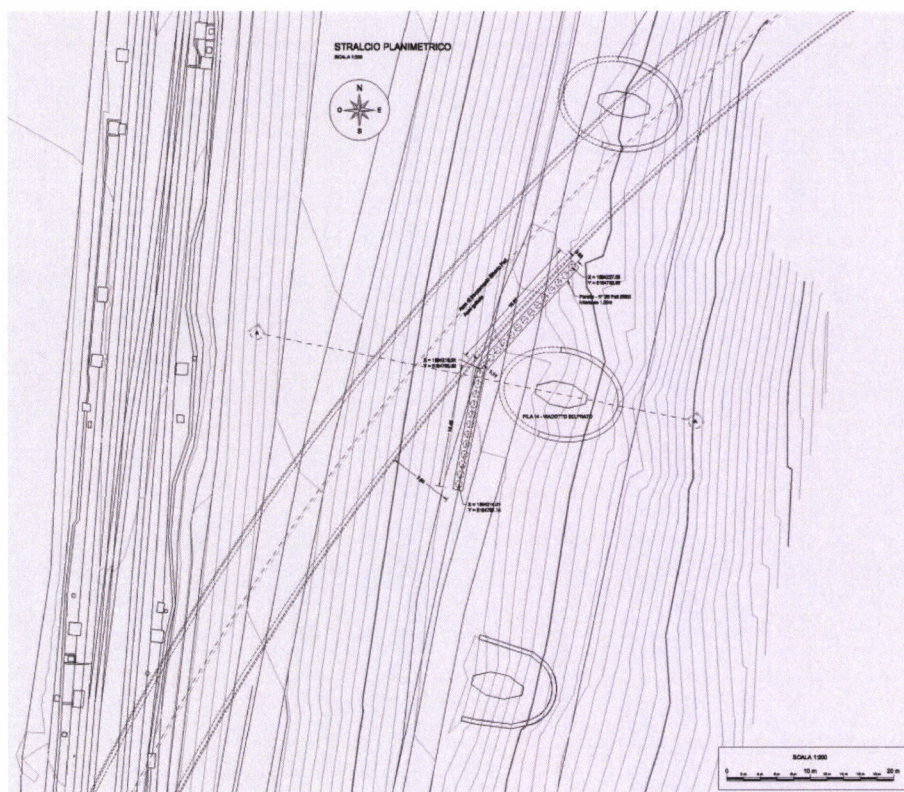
Planimetria della zona interessata dall'intervento con pali di cinturazione davanti alla pila 14
